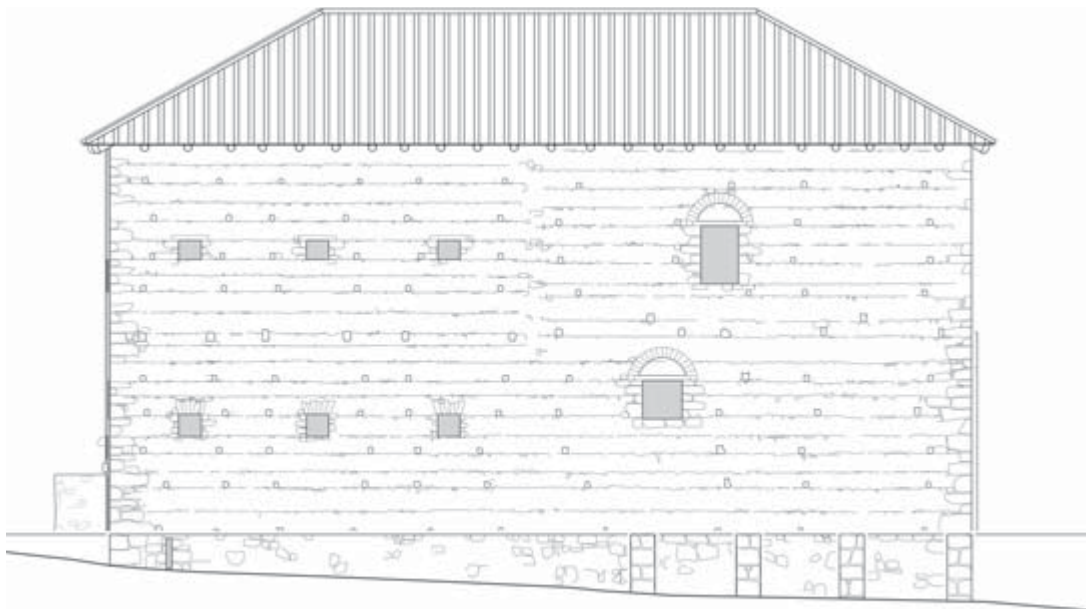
Kirse Yanı, Rekonstruktion, N-Ansicht
